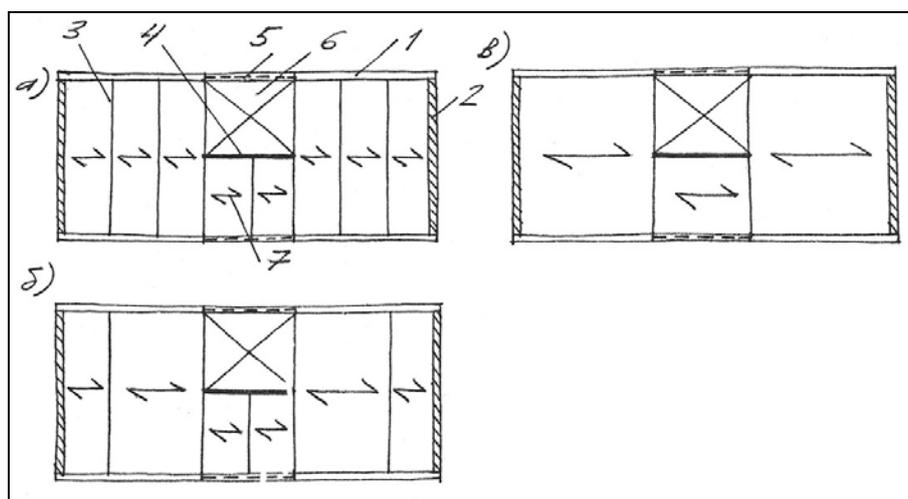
Поперечно-стеновые конструктивные системы с перекрытиями:
